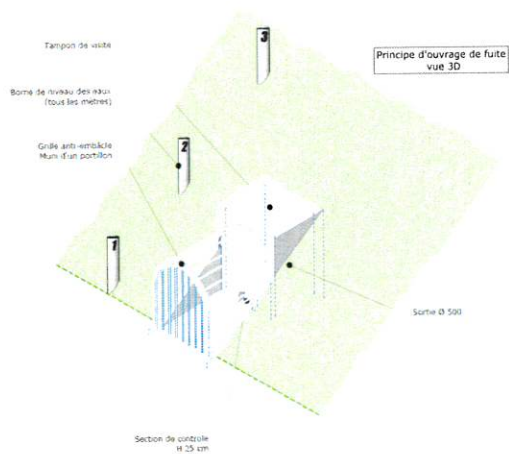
schéma de principe de l'ouvrage de fuite de l'ouvrage Essart 1 (source : Ingetec)
